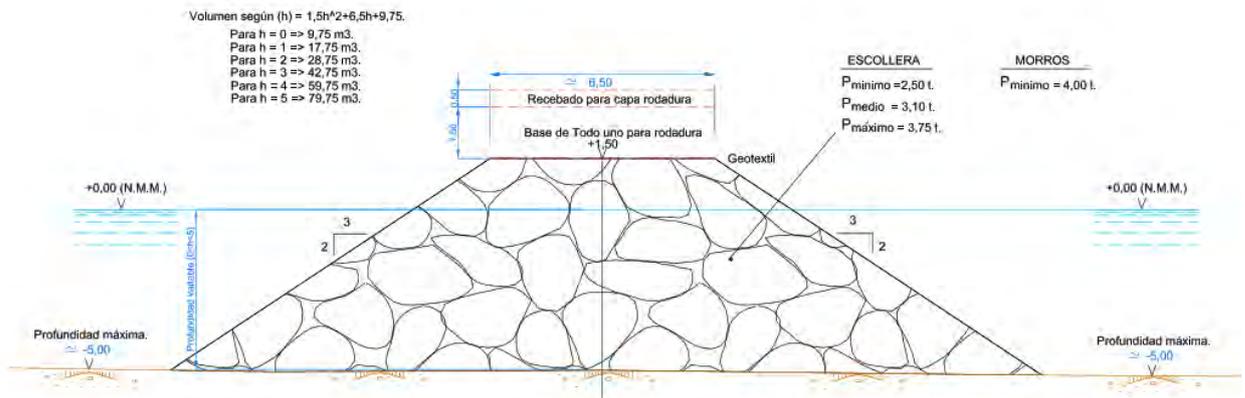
Sección tipo de los espigones (Fuente: Proyecto constructivo 2018)
